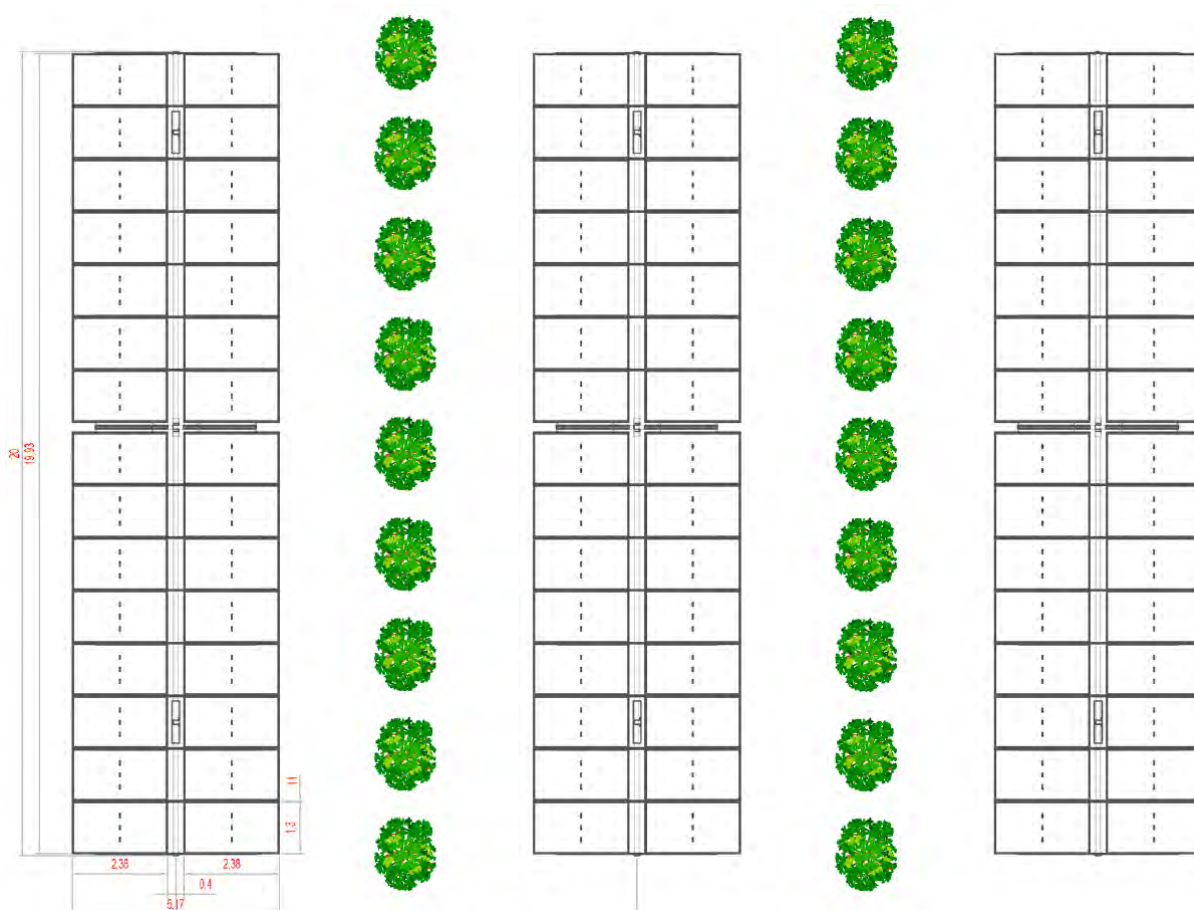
Dettaglio delle file dell'Oliveto tra le strutture dell'impianto fotovoltaico
